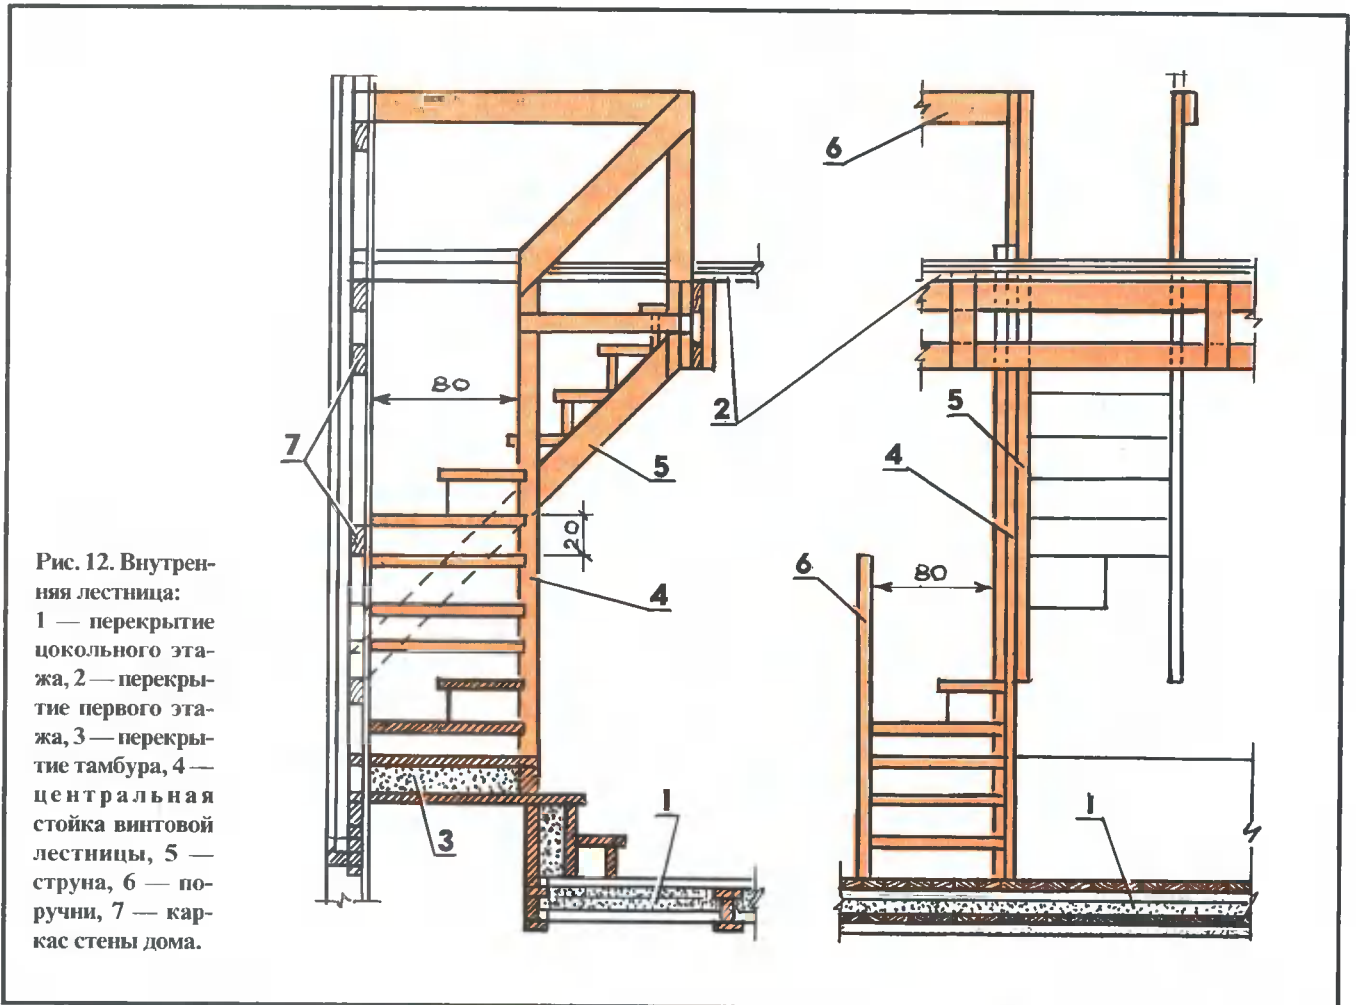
Внутренняя лестница: 1 — перекрытие цокольного этажа, 2 — перекрытие первого этажа, 3 — перекрытие тамбура, 4 — центральная стойка винтовой лестницы, 5 — струна, 6 — поручни, 7 — каркас стены дома.
